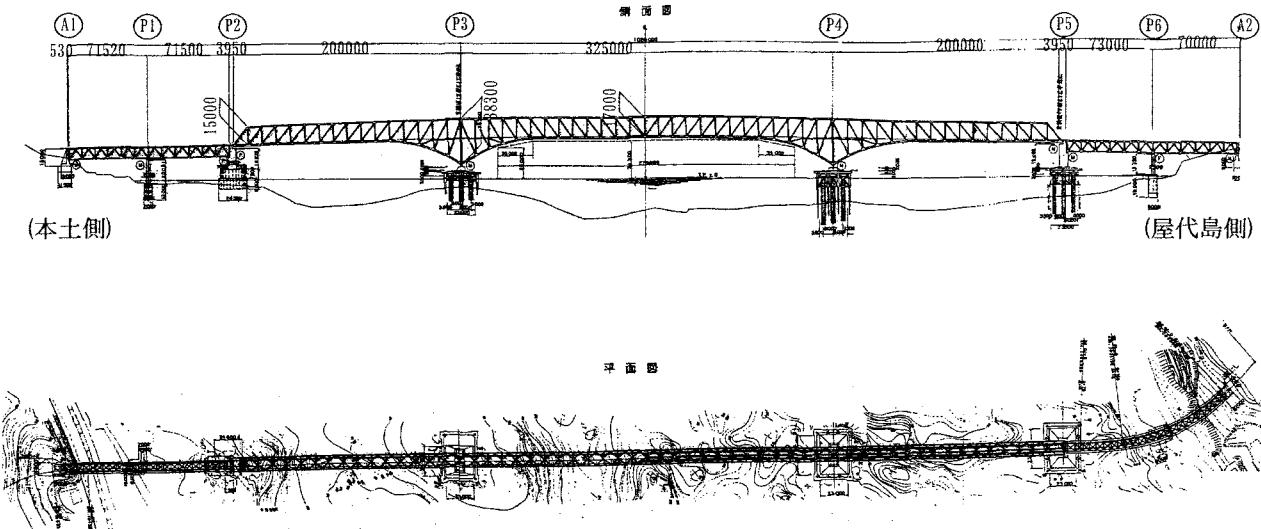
検討対象橋梁の全体一般図（上：側面図、下：平面図）
